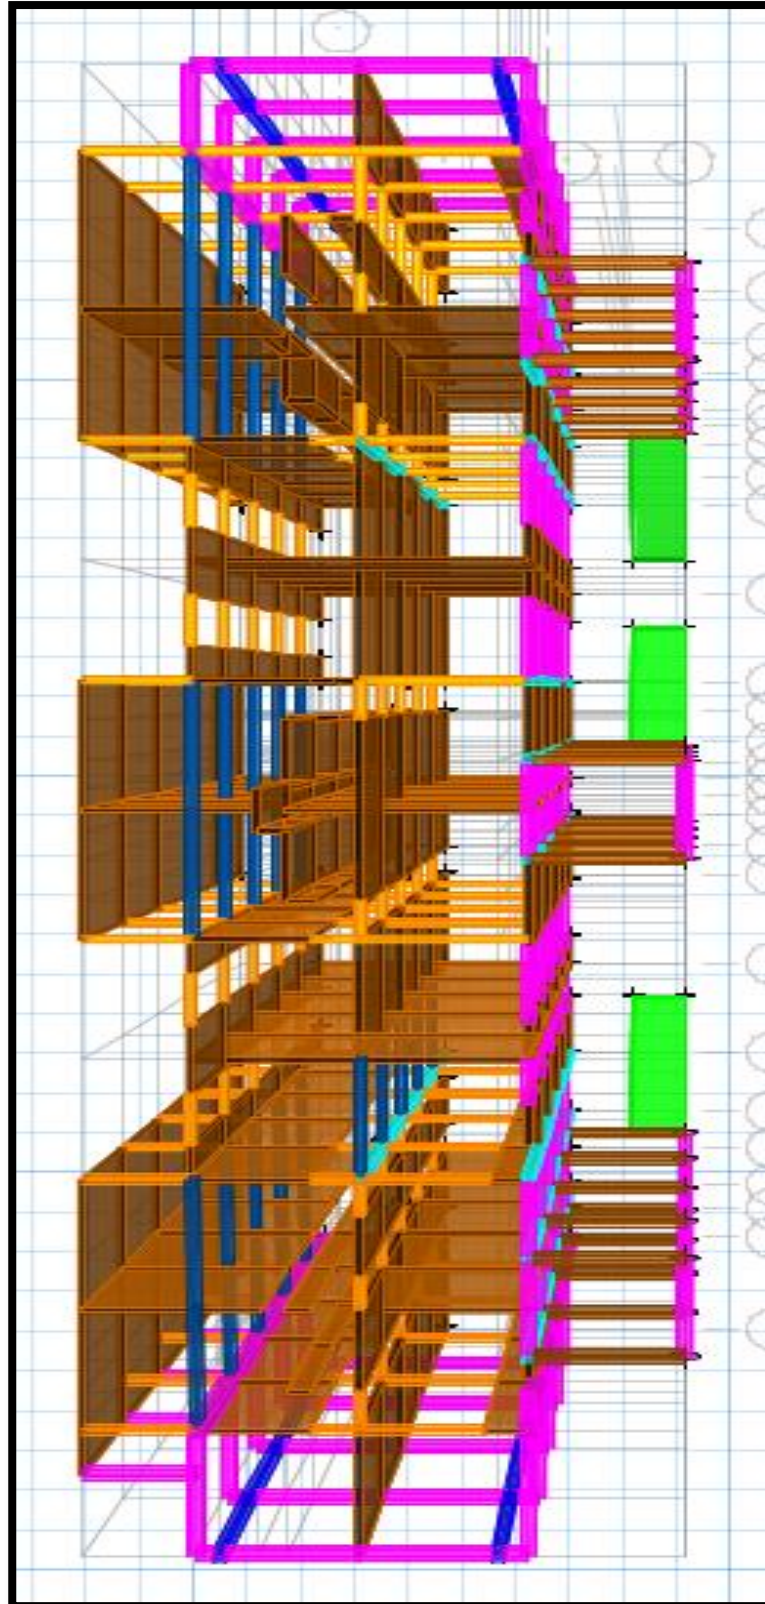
Vista de Vigas y Muros de Modulo 01 (Muros de Albañilería Confinada)
